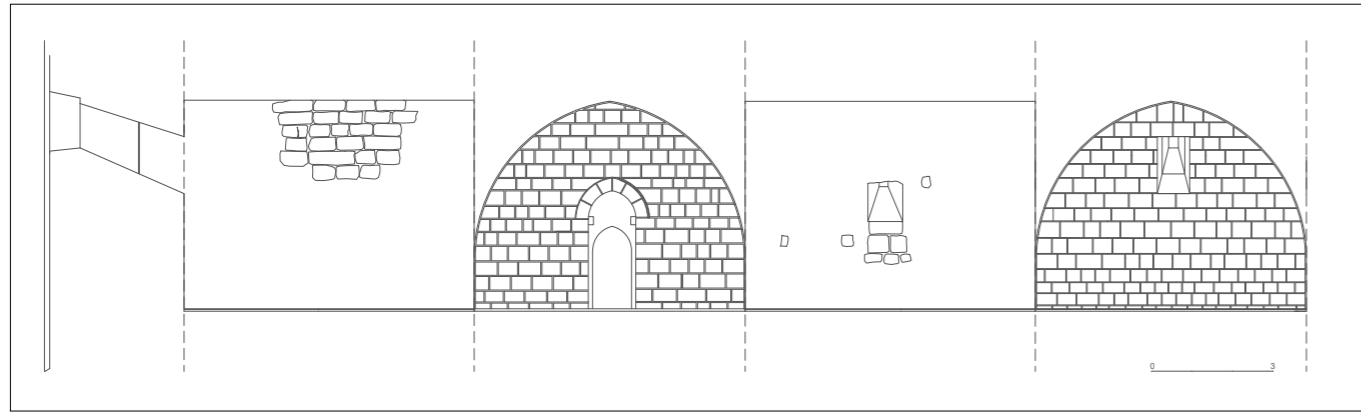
Desarrollo de alzados de la cámara bajo la torre suroeste. Proyecto de restauración ambiental. (MJB 2013).
